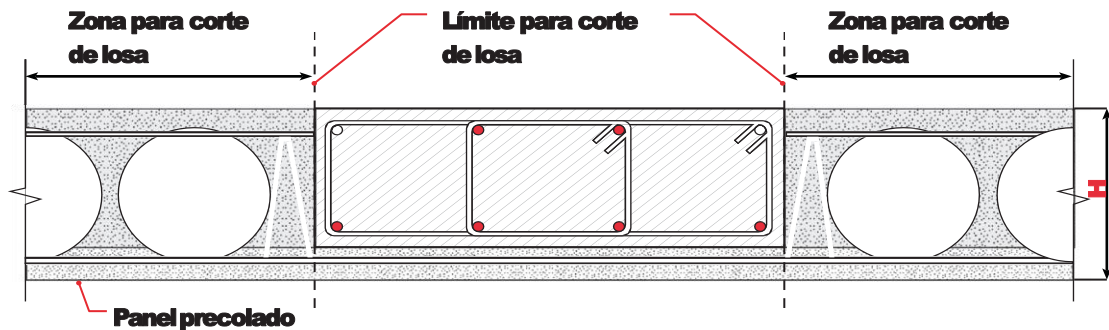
Detalle de trabe para cortes con máximas dimensiones
